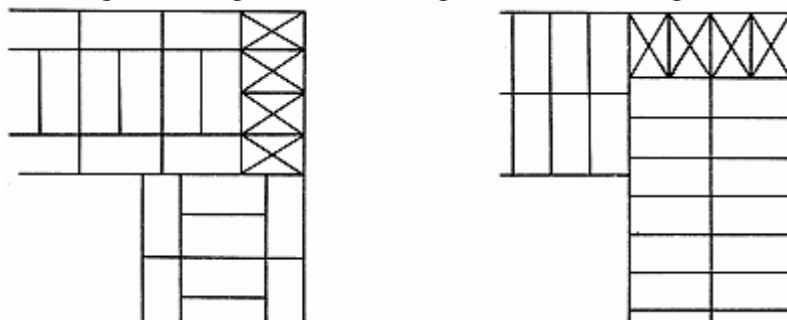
Кладка угла стены в два кирпича при двухрядной перевязке
